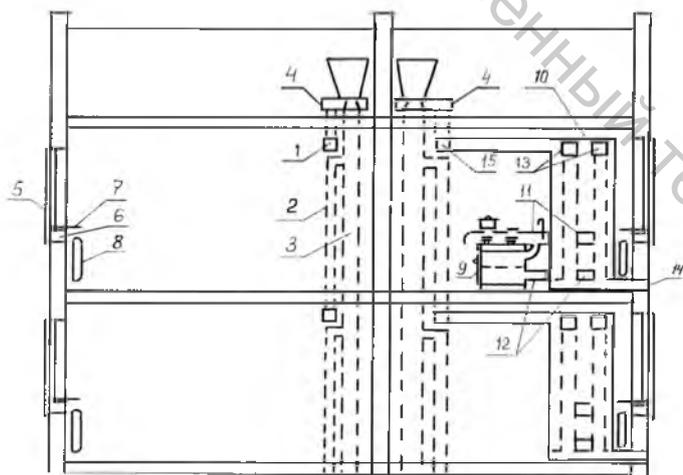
Комплексная схема теплогоснабжения и вентиляции герметизированных высотных зданий с теплыми чердаками: 1 – вытяжная вентиляционная решетка; 2 – отвлечение канала вытяжного вентблока; 3 – ствол вытяжного канала вентблока; 4 – эжекторный оголовок вытяжного вентшхты; 5 – солнечный подогреватель воздуха; 6 – рекуперативный приточный вентиляционный элемент; 7 – подоконная плита; 8 – отопительный прибор; 9 – газовая плита; 10 – теплообменник газовой плиты; 11, 12 – верхний, нижний соединительные патрубки; 13 – выпускные отверстия; 14 – воздухоприемные отверстия теплообменника газовой плиты; 15 – соединительный патрубок теплообменника к вытяжному каналу
